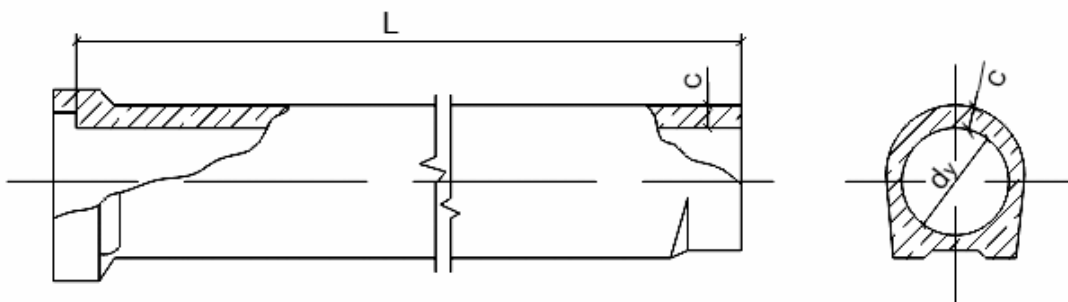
Трубы железобетонные безнапорные типа РТП
